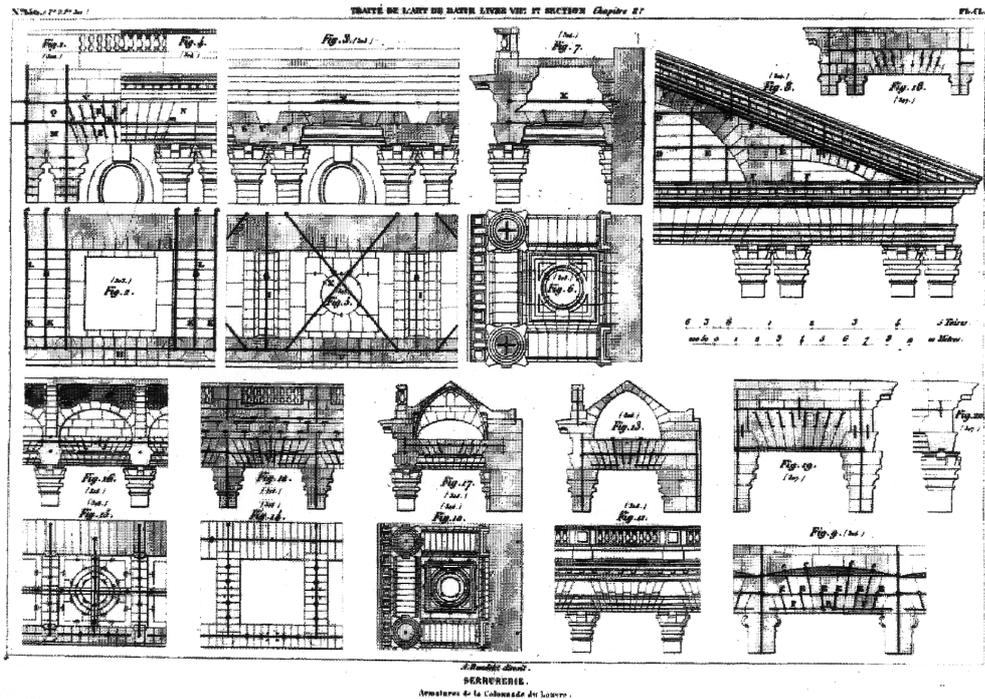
Claude Perrault, columnata y alzado oriental del Louvre, Paris, 1665. Técnicas medievales de grapas de hierro forjado aplicadas a una construcción trabada en piedra de gran extensión.
